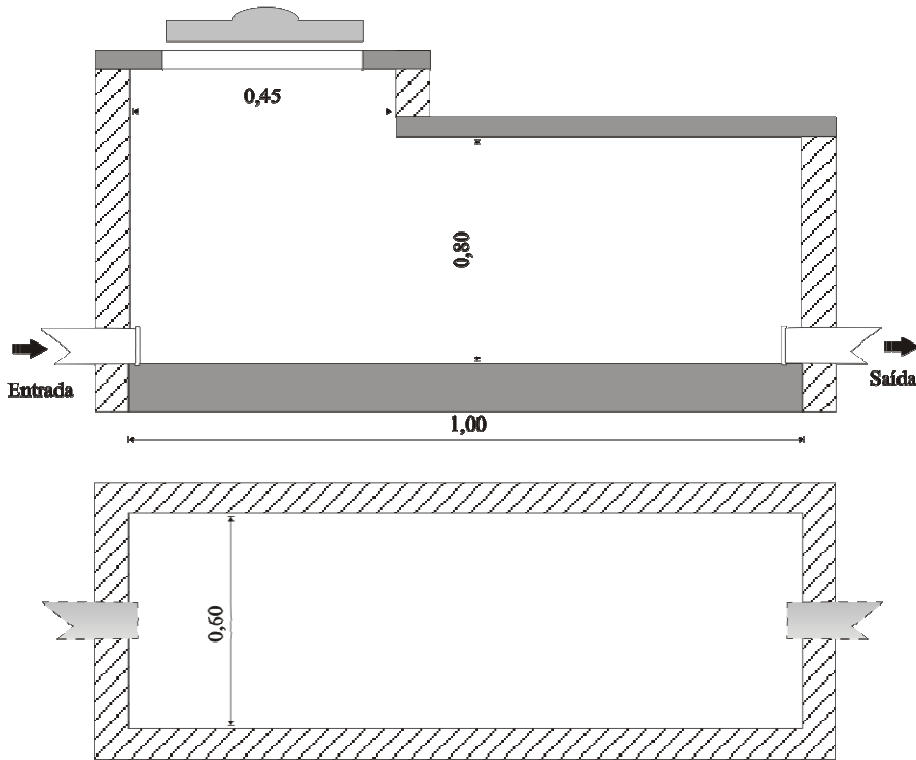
Detalhe do dimensionamento da caixa de inspeção
